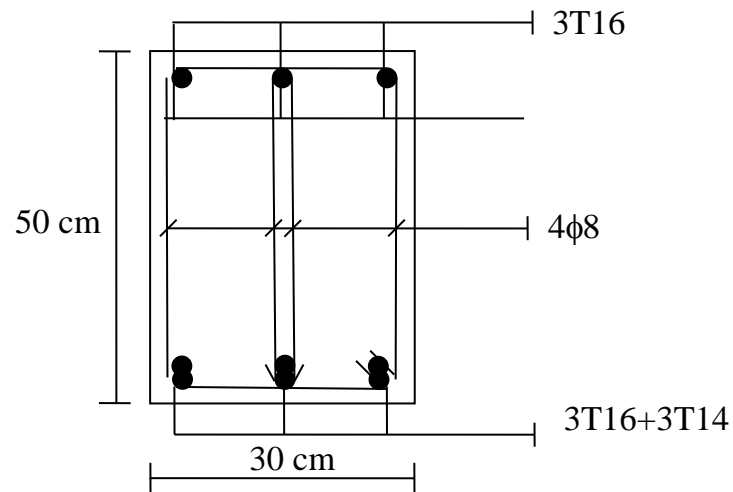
Schéma de ferrailage de la poutre principale (Travée)
